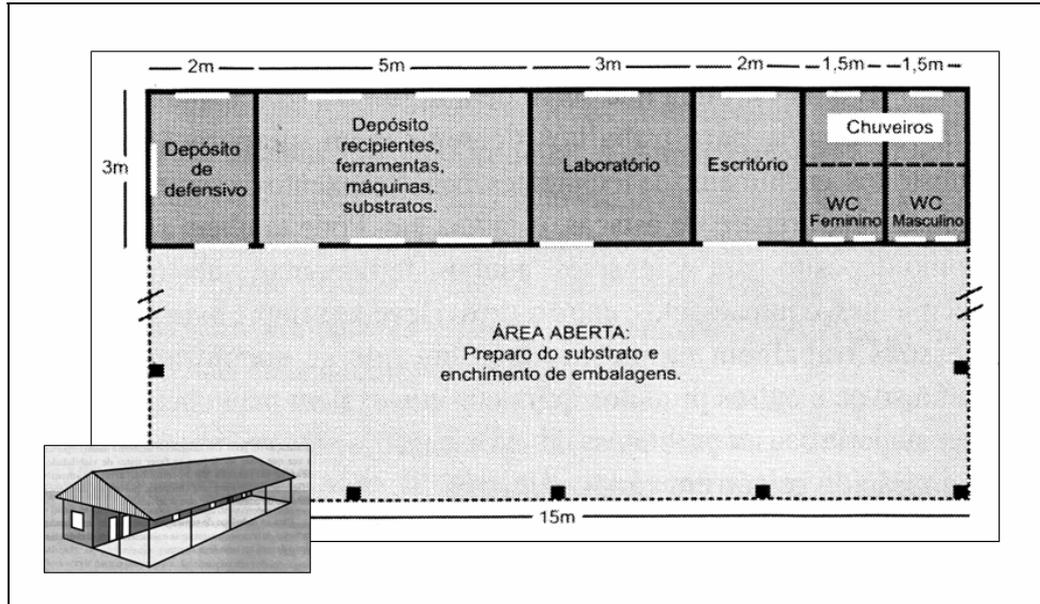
Planta física do galpão. Fonte: adaptado de Wendling e Gatto (2001).
